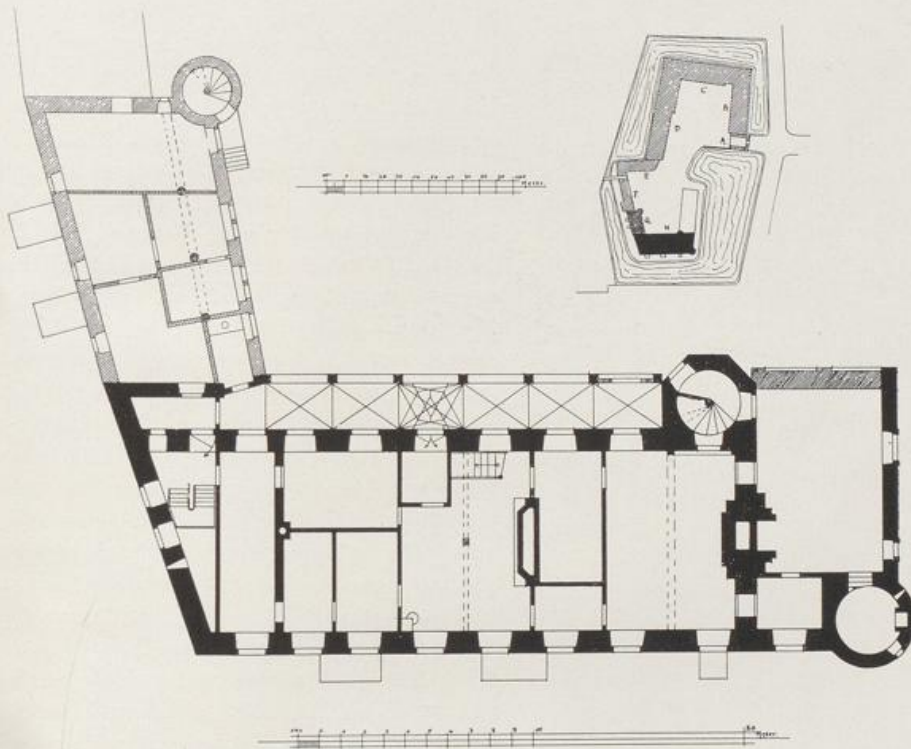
Binsfelder Burg. Lageplan und Grundriss des Erdgeschosses.
